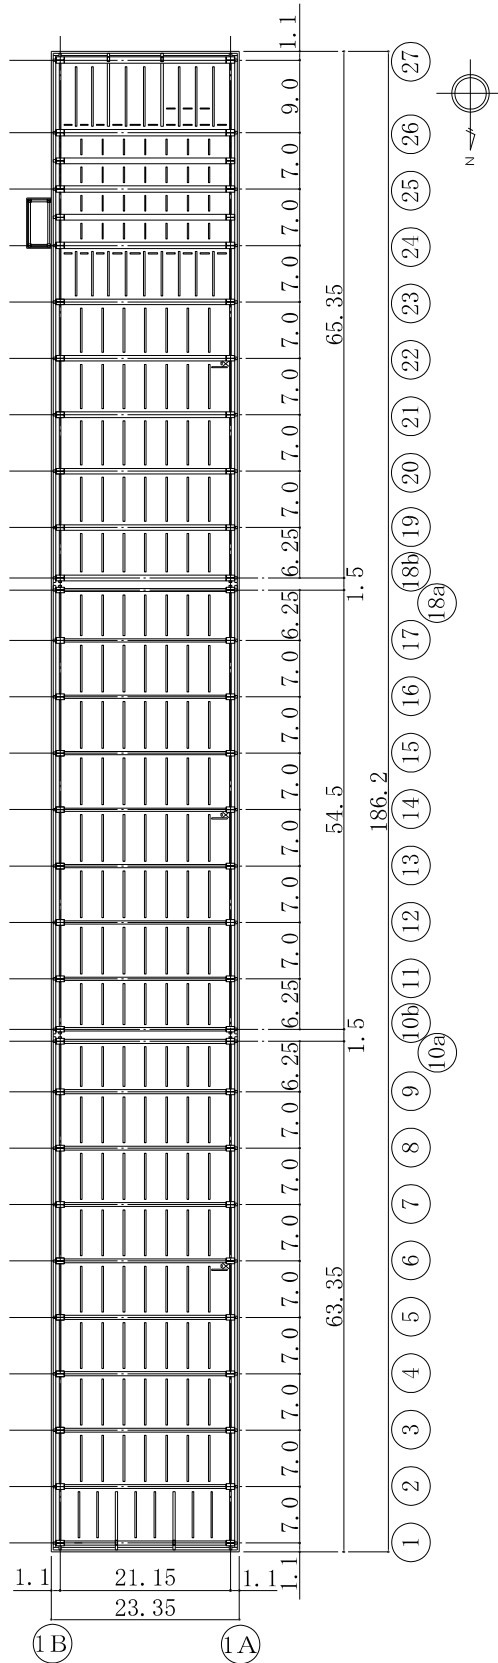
2階平面図 (G. L. +16.650) (单位 : m)
